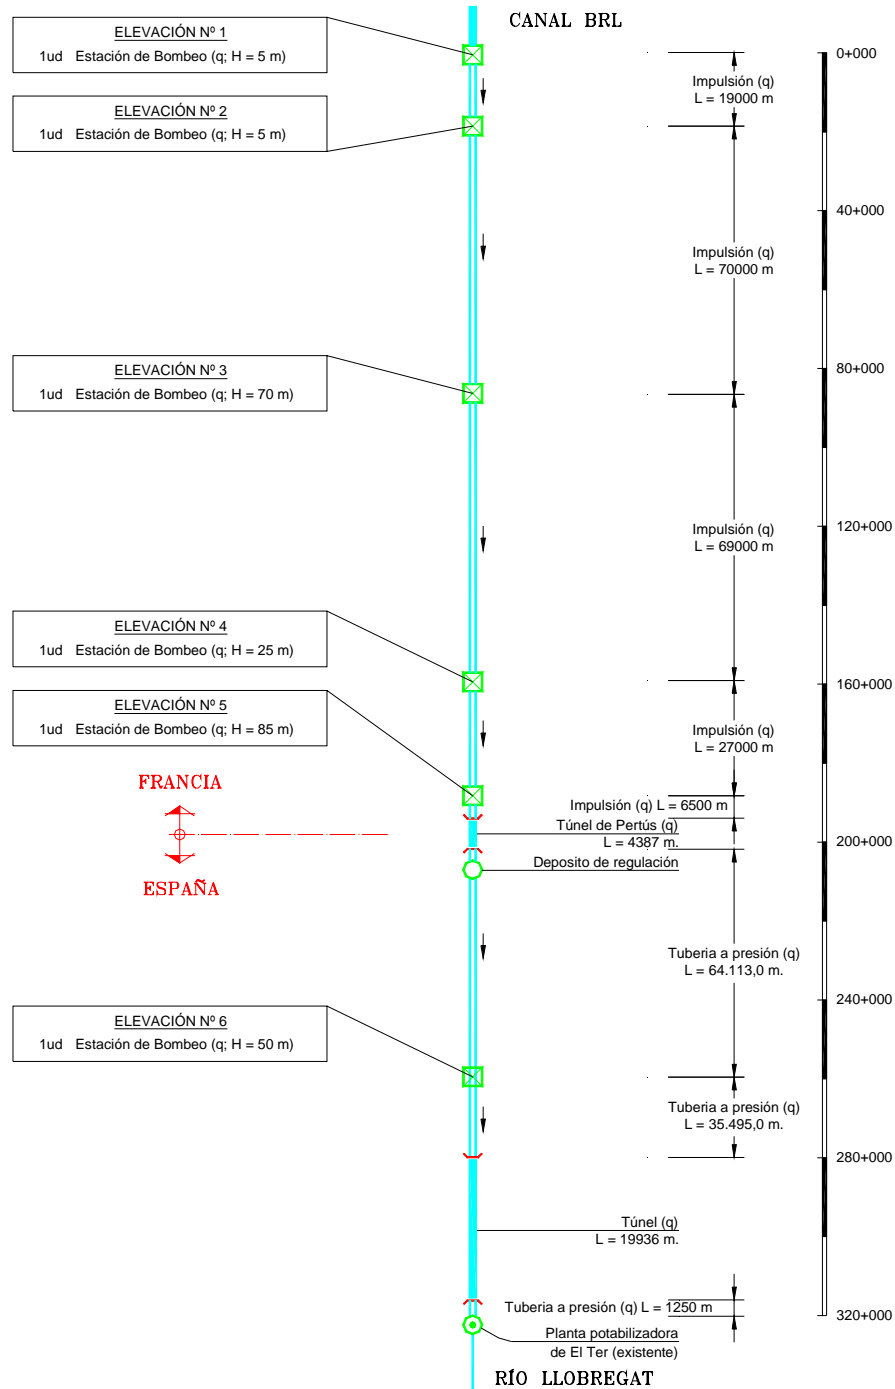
Conducci3n R3dano - Barcelona. Esquema en planta
